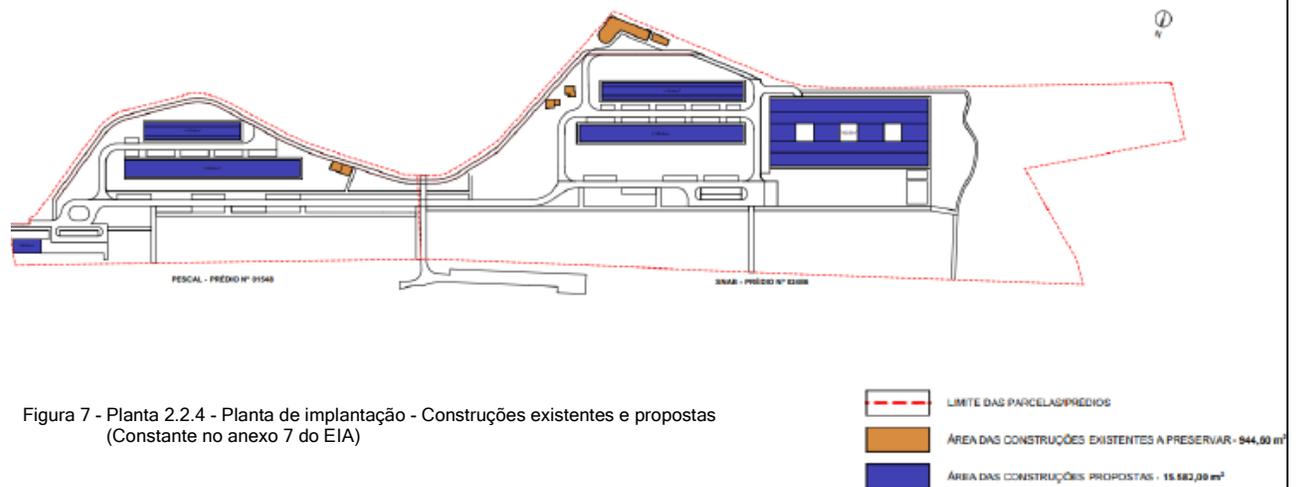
Planta 2.2.4 - Planta de implantação - Construções existentes e propostas (Constante no anexo 7 do EIA)
